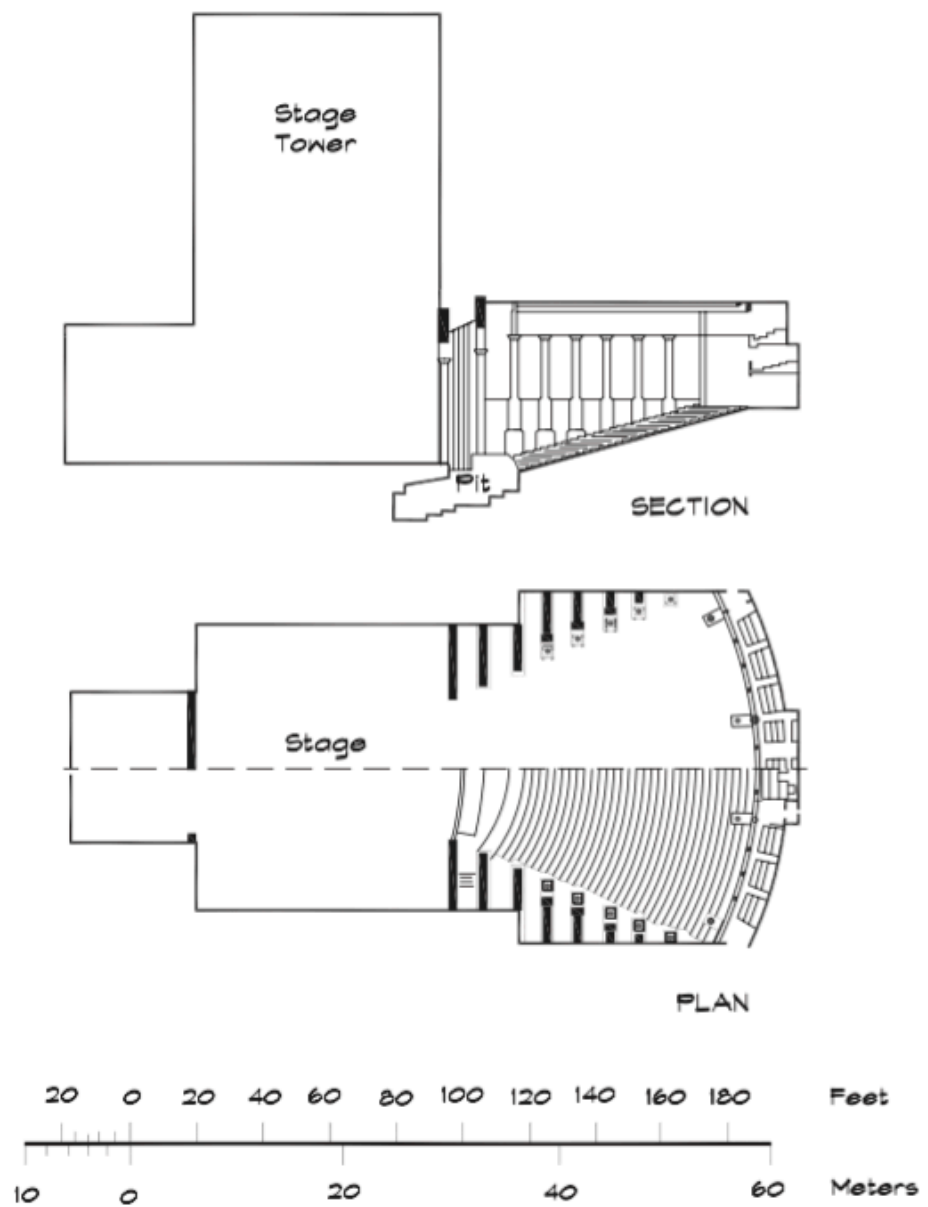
Corte e Planta da Festpielhaus, Bayreuth, Alemanha (LONG, 2006:26).
